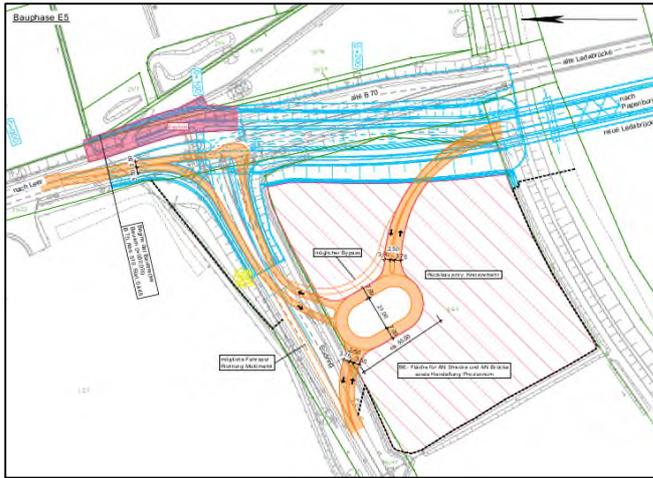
Lageplan Bauphasenplan Nord, Bauphase E5
